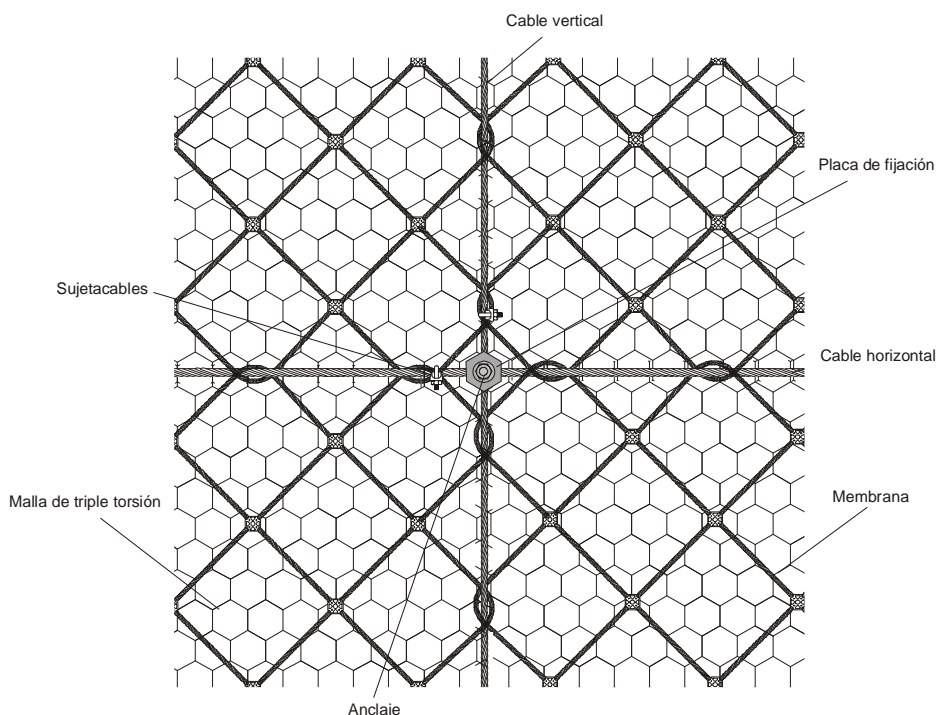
Detalle del anclaje interior en la zona de unión entre paños de red.
